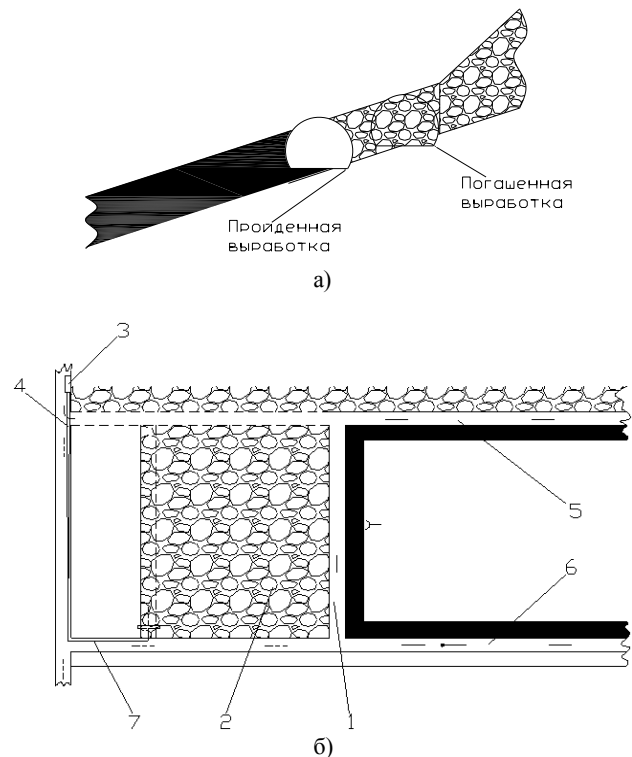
Технологическая схема очистных работ: а – разрез; б – план: 1 – лава; 2 – выработанное пространство; 3 – камера смещения; 4 – трубопровод для изолированного отвода метана; 5 – вентиляционная выработка; 6 – конвейерная выработка; 7 – дегазационный газопровод
